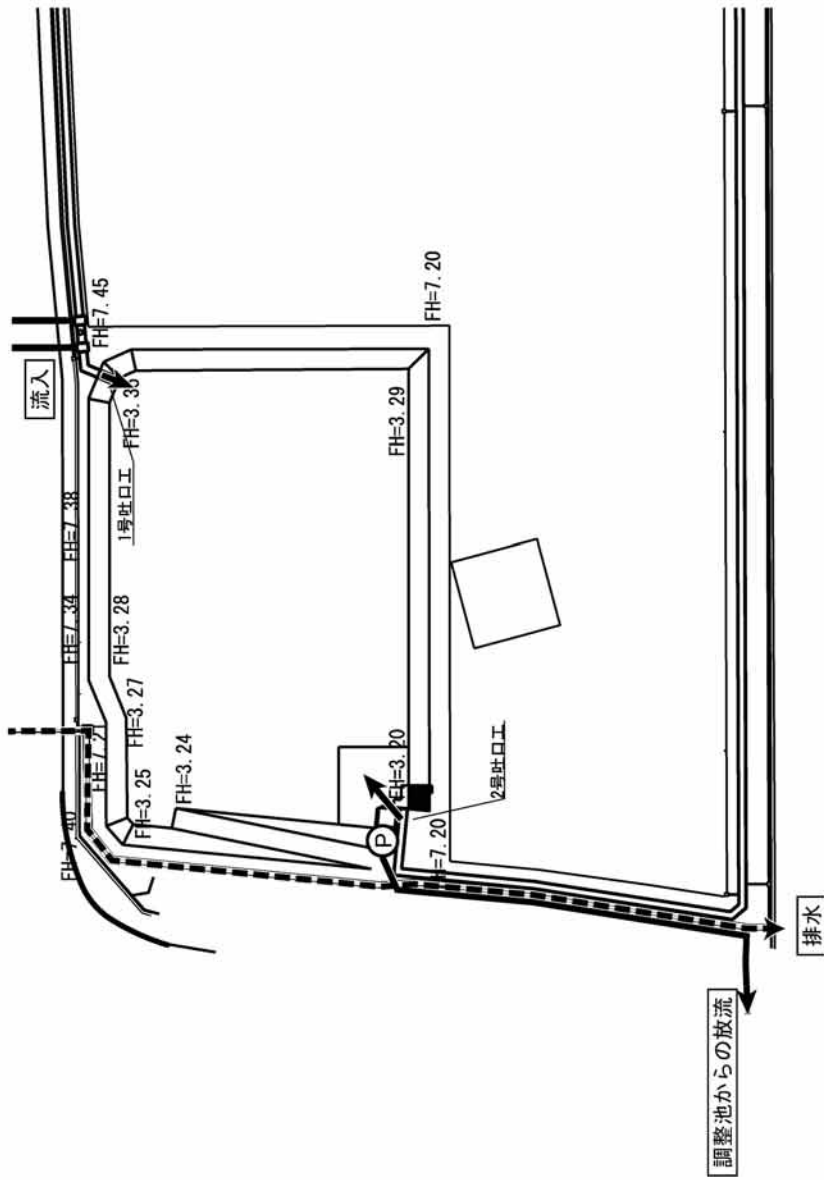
(2) 調整池計画平面・断面図 (第1調整池) 【第1回変更】
